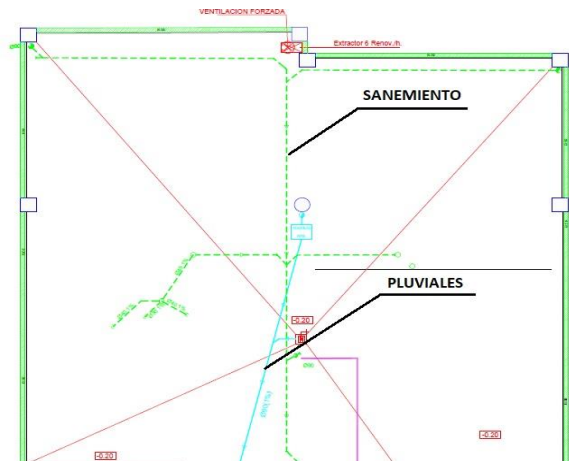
Instalación de saneamiento en planta garaje. Fuente: Proyecto original.
